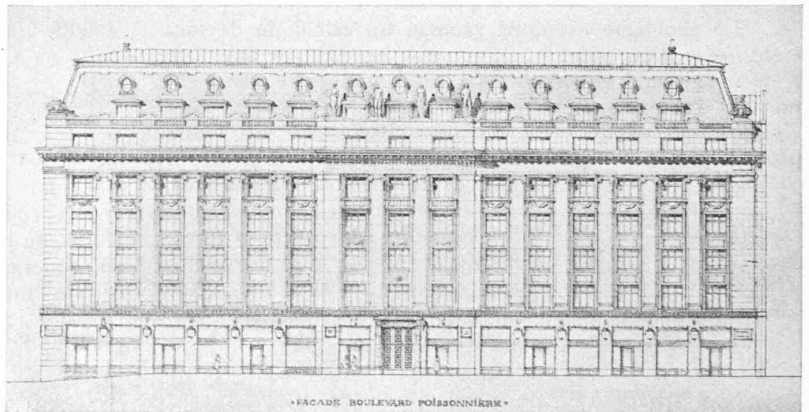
Variante für die Hauptfassade nach Pariser Geschmack. — 1:600.
